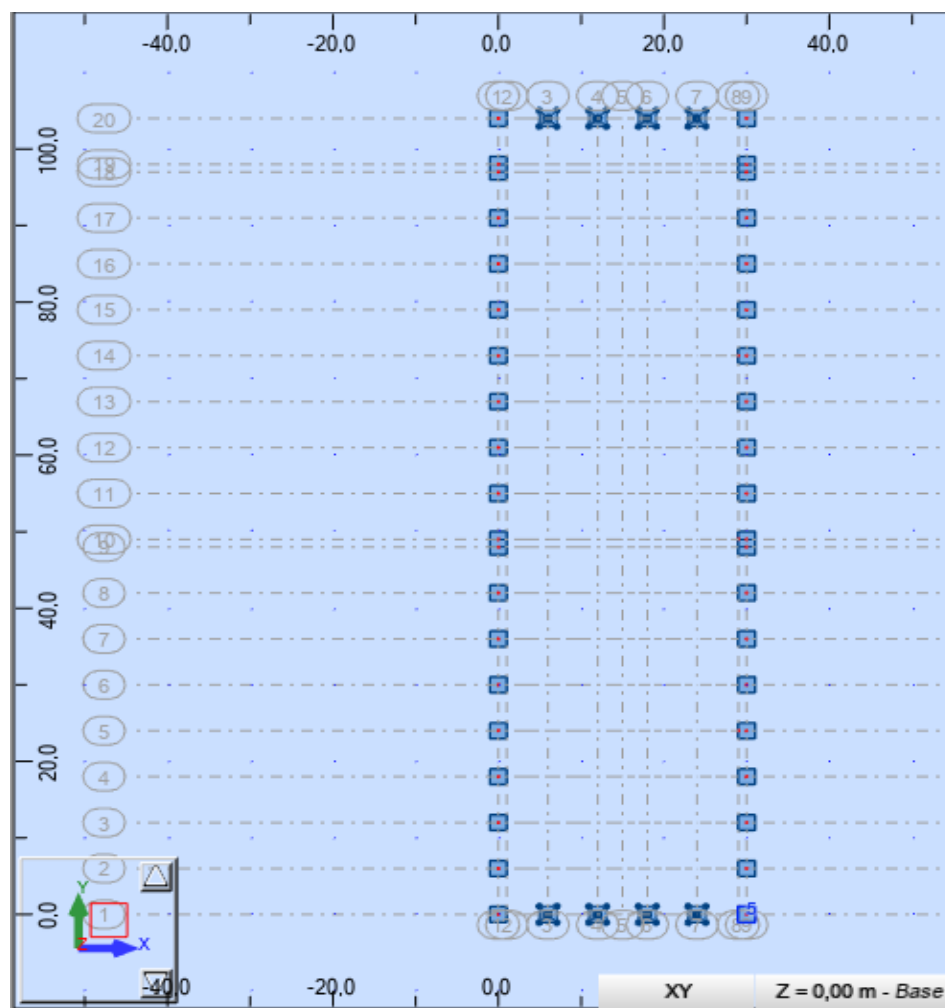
Vue en plan de l'ouvrage Z=0m
